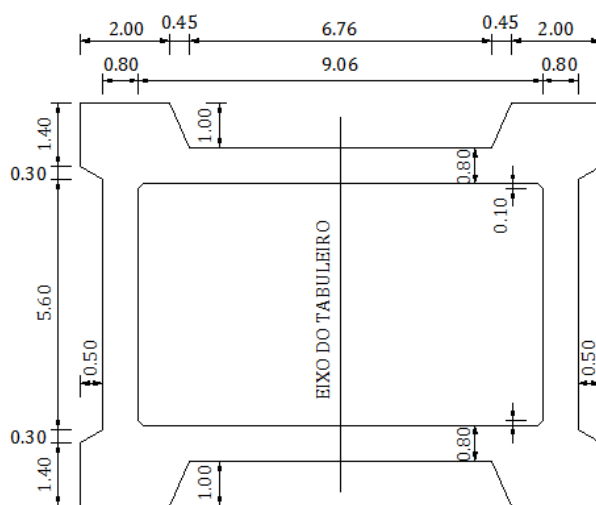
Secção transversal do pilar (caso de estudo 6)
